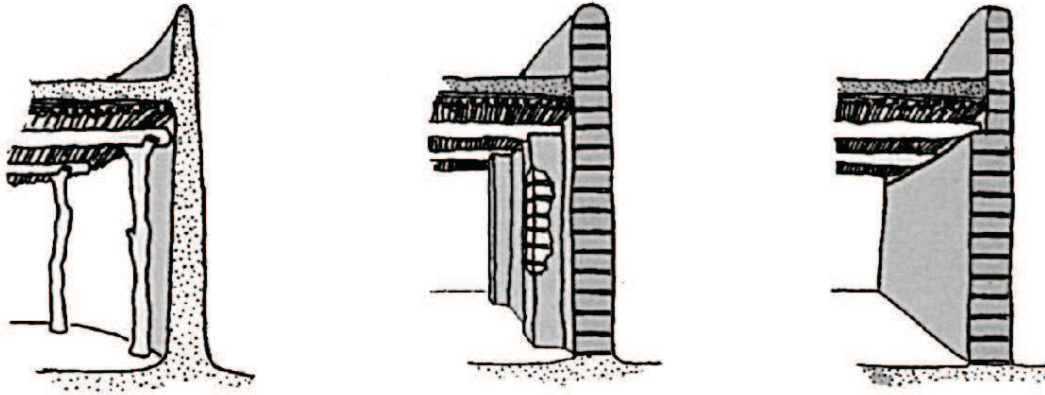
Varianten eines Dachaufbaus beim Lehm- bau: Li: Lehmballenmauerwerk mit sekundärer Tragkonstruktion zur Lastabtragung; Mi und re: Adobe Lehmmauerwerk mit direkt auflagernder Dachkonstruktion, das Mauerwerk ist massiv genug um die Lasten selbst abzutragen
